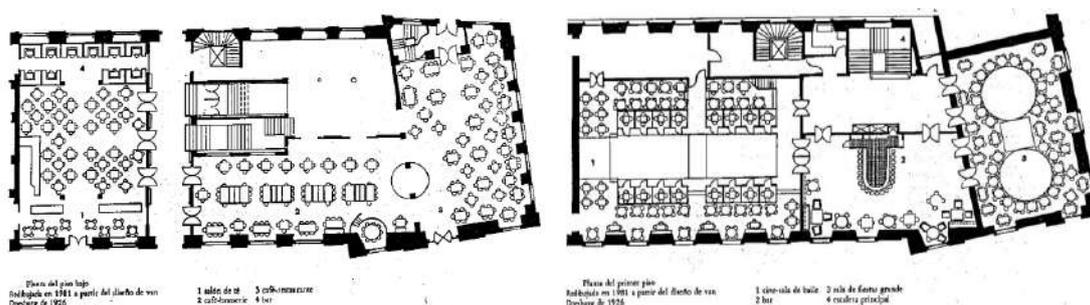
Planta Baixa Técnica Pavimento Térreo (esquerda) Ciné-Dancing.
